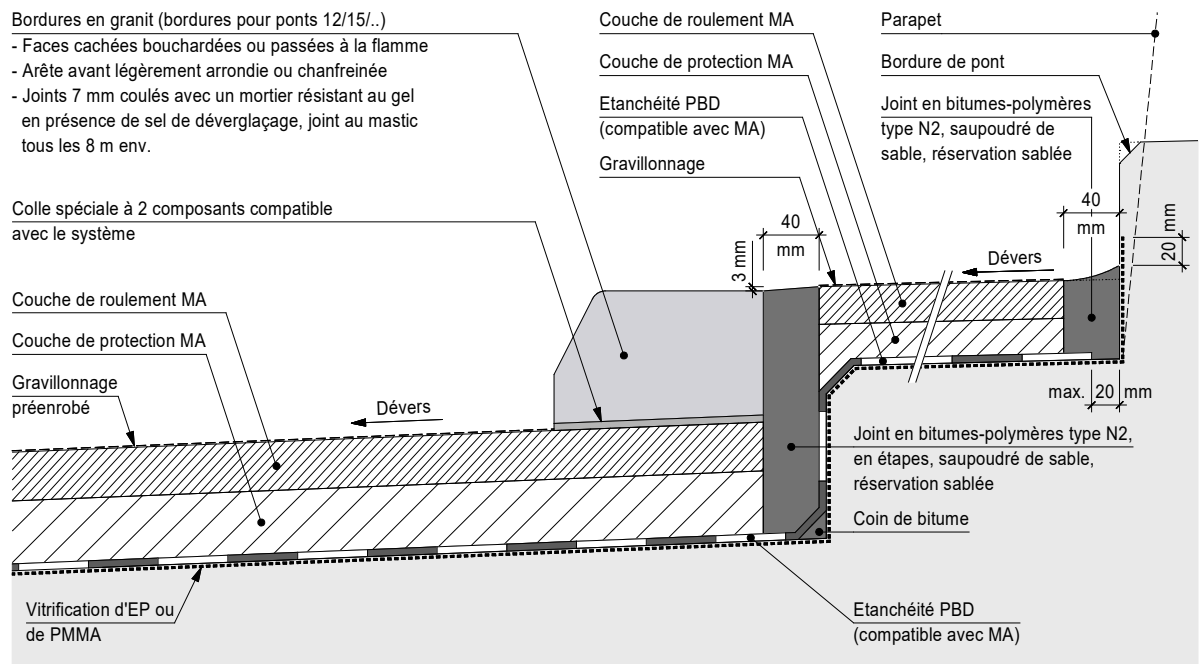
Système d'étanchéité PBD - Raccord aux trottoirs - Bordure de trottoir collée - Point haut
